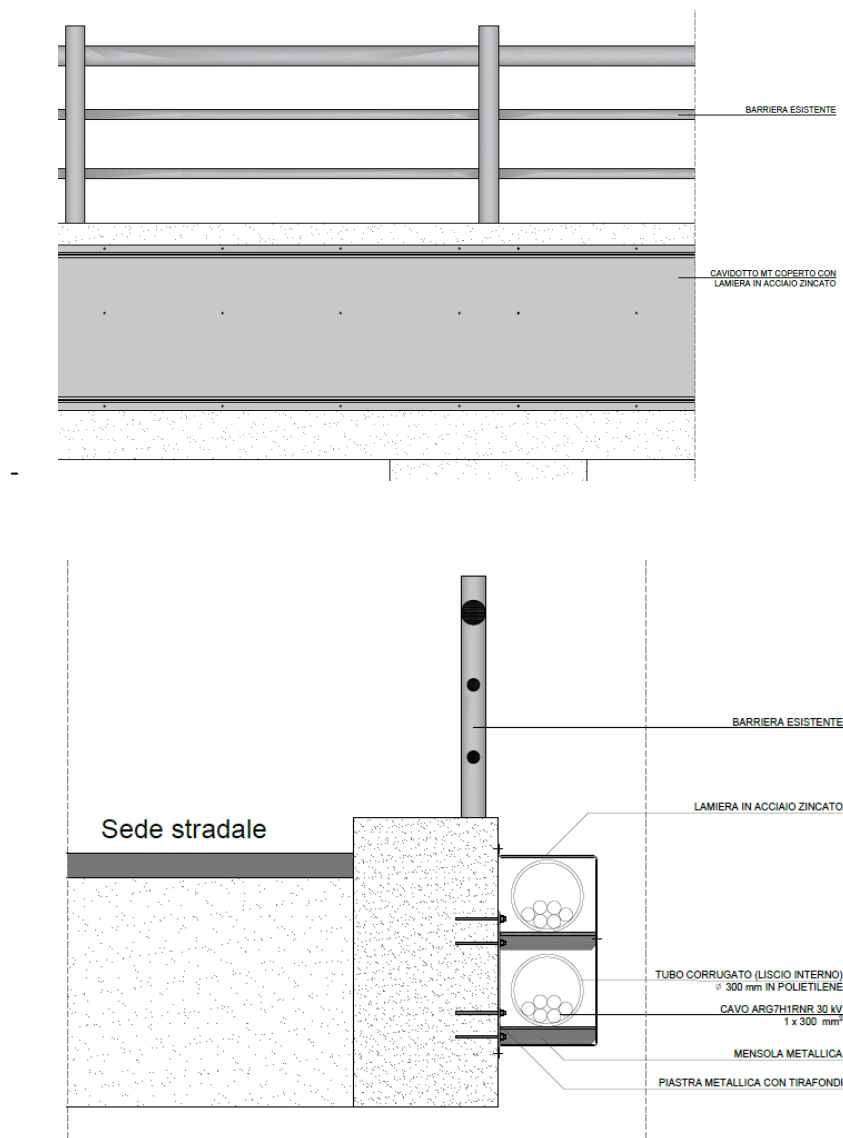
Particolare costruttivo dell'attraversamento del ponte
